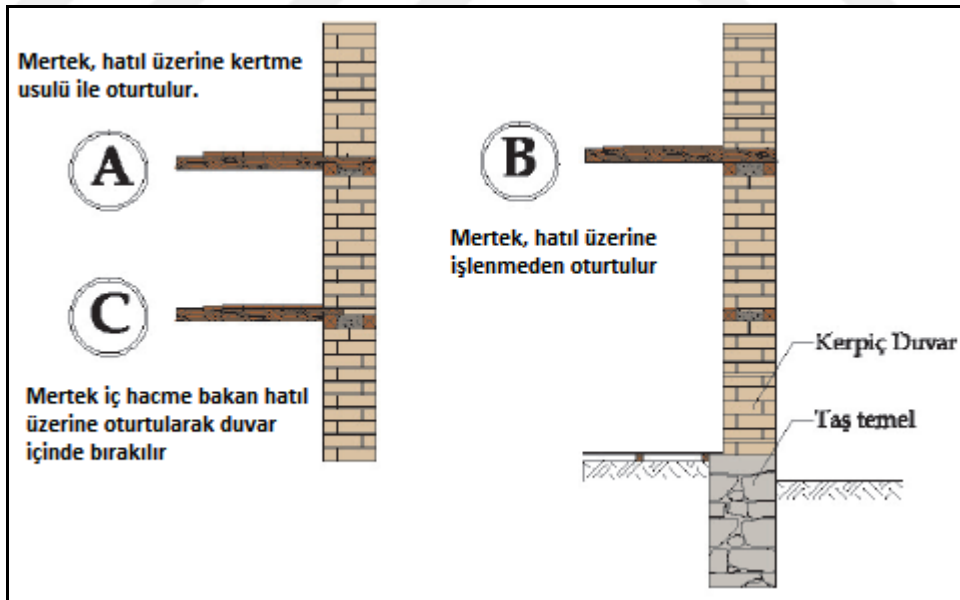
15 Yığma kerpiç yapıda hatıl ve döşeme detay planı
